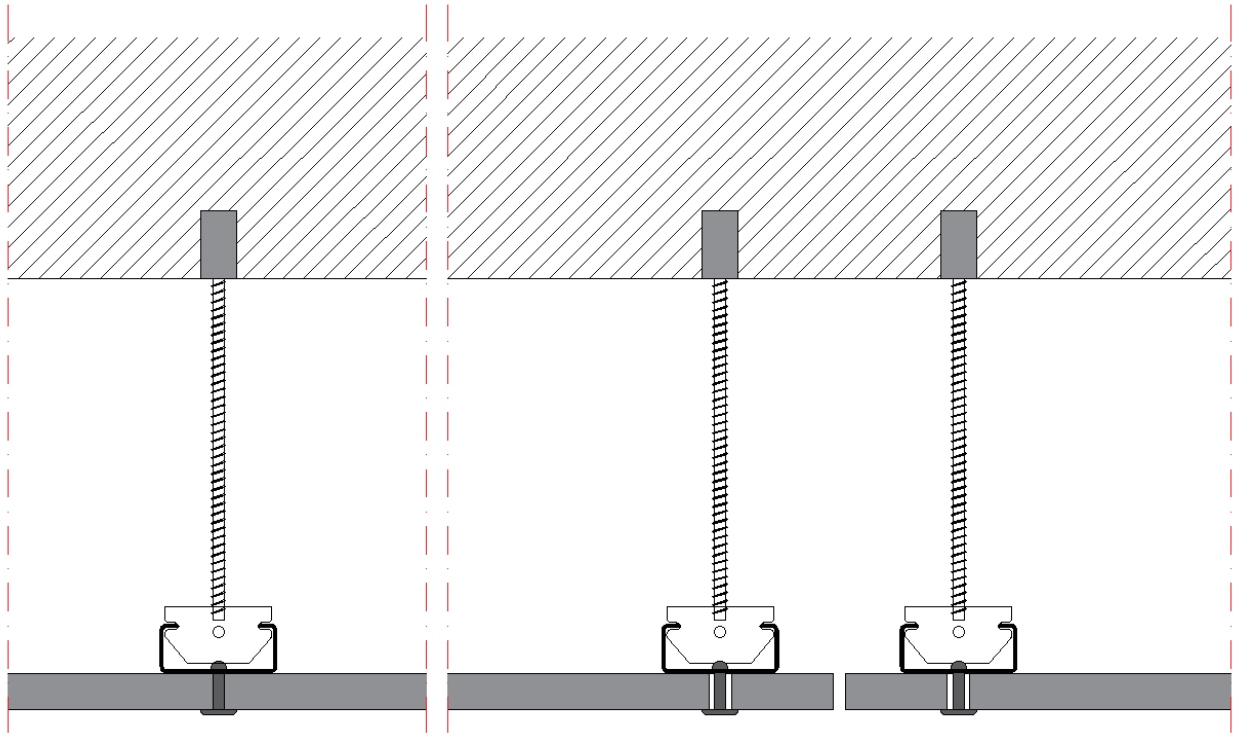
Teto com estrutura TC de aço galvanizado
